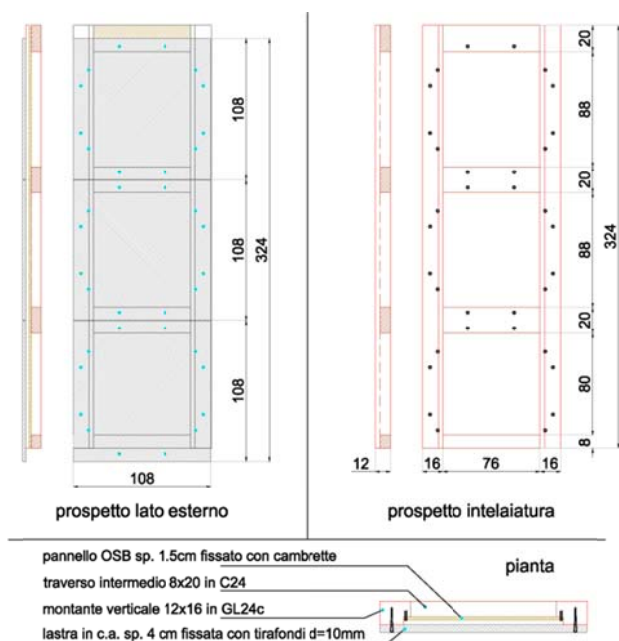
Parete tipologica del sistema COSTRUCTURE. Pianta Prospetto e sezione verticale.
